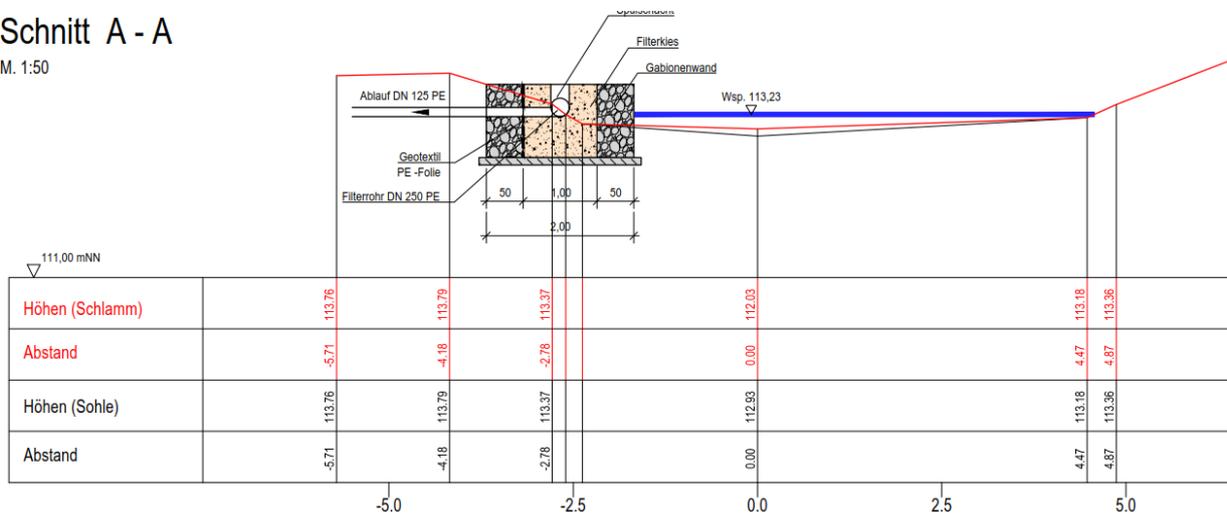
Querschnitt der geplanten Steingabione mit Filter für Überleitung in den Waldbereich
